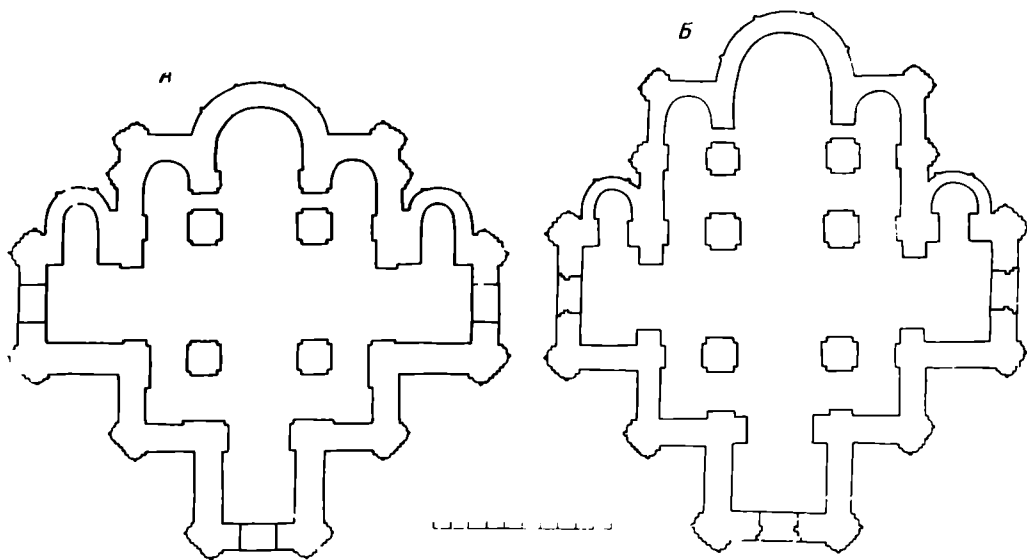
А — план собора Троицкого монастыря (реконструкция); Б — план церкви архангела Михаила
